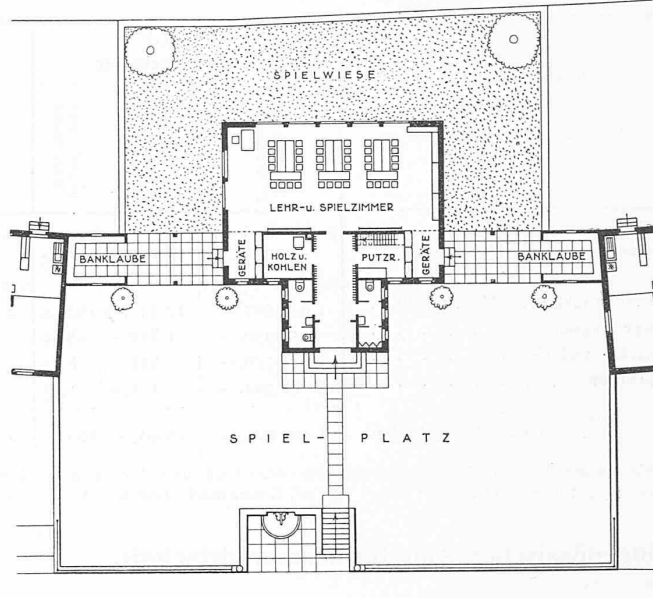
Grundriss des Kindergartenhauses Utohof. — 1 : 400.
